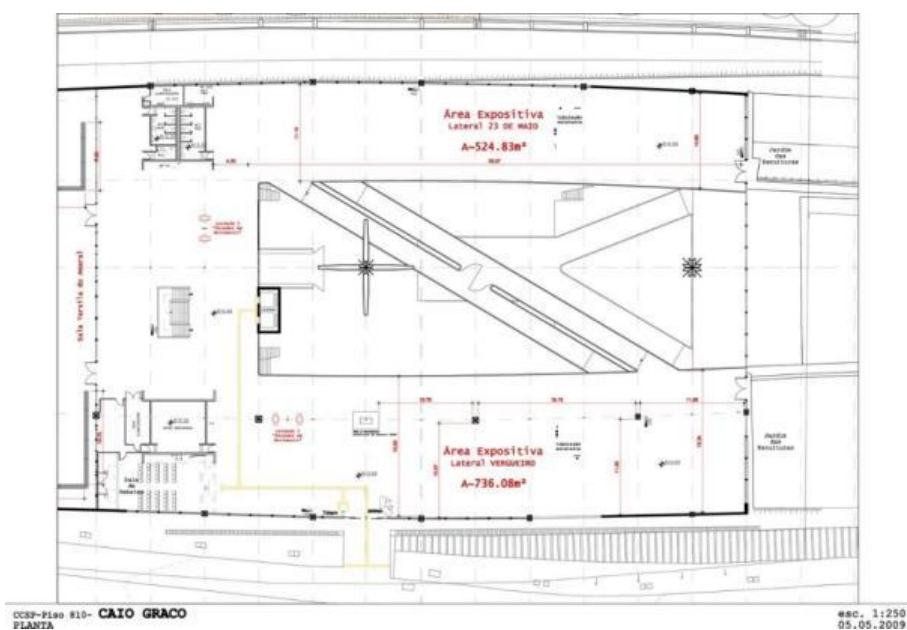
Planta T rrea do Centro Cultural S o Paulo
